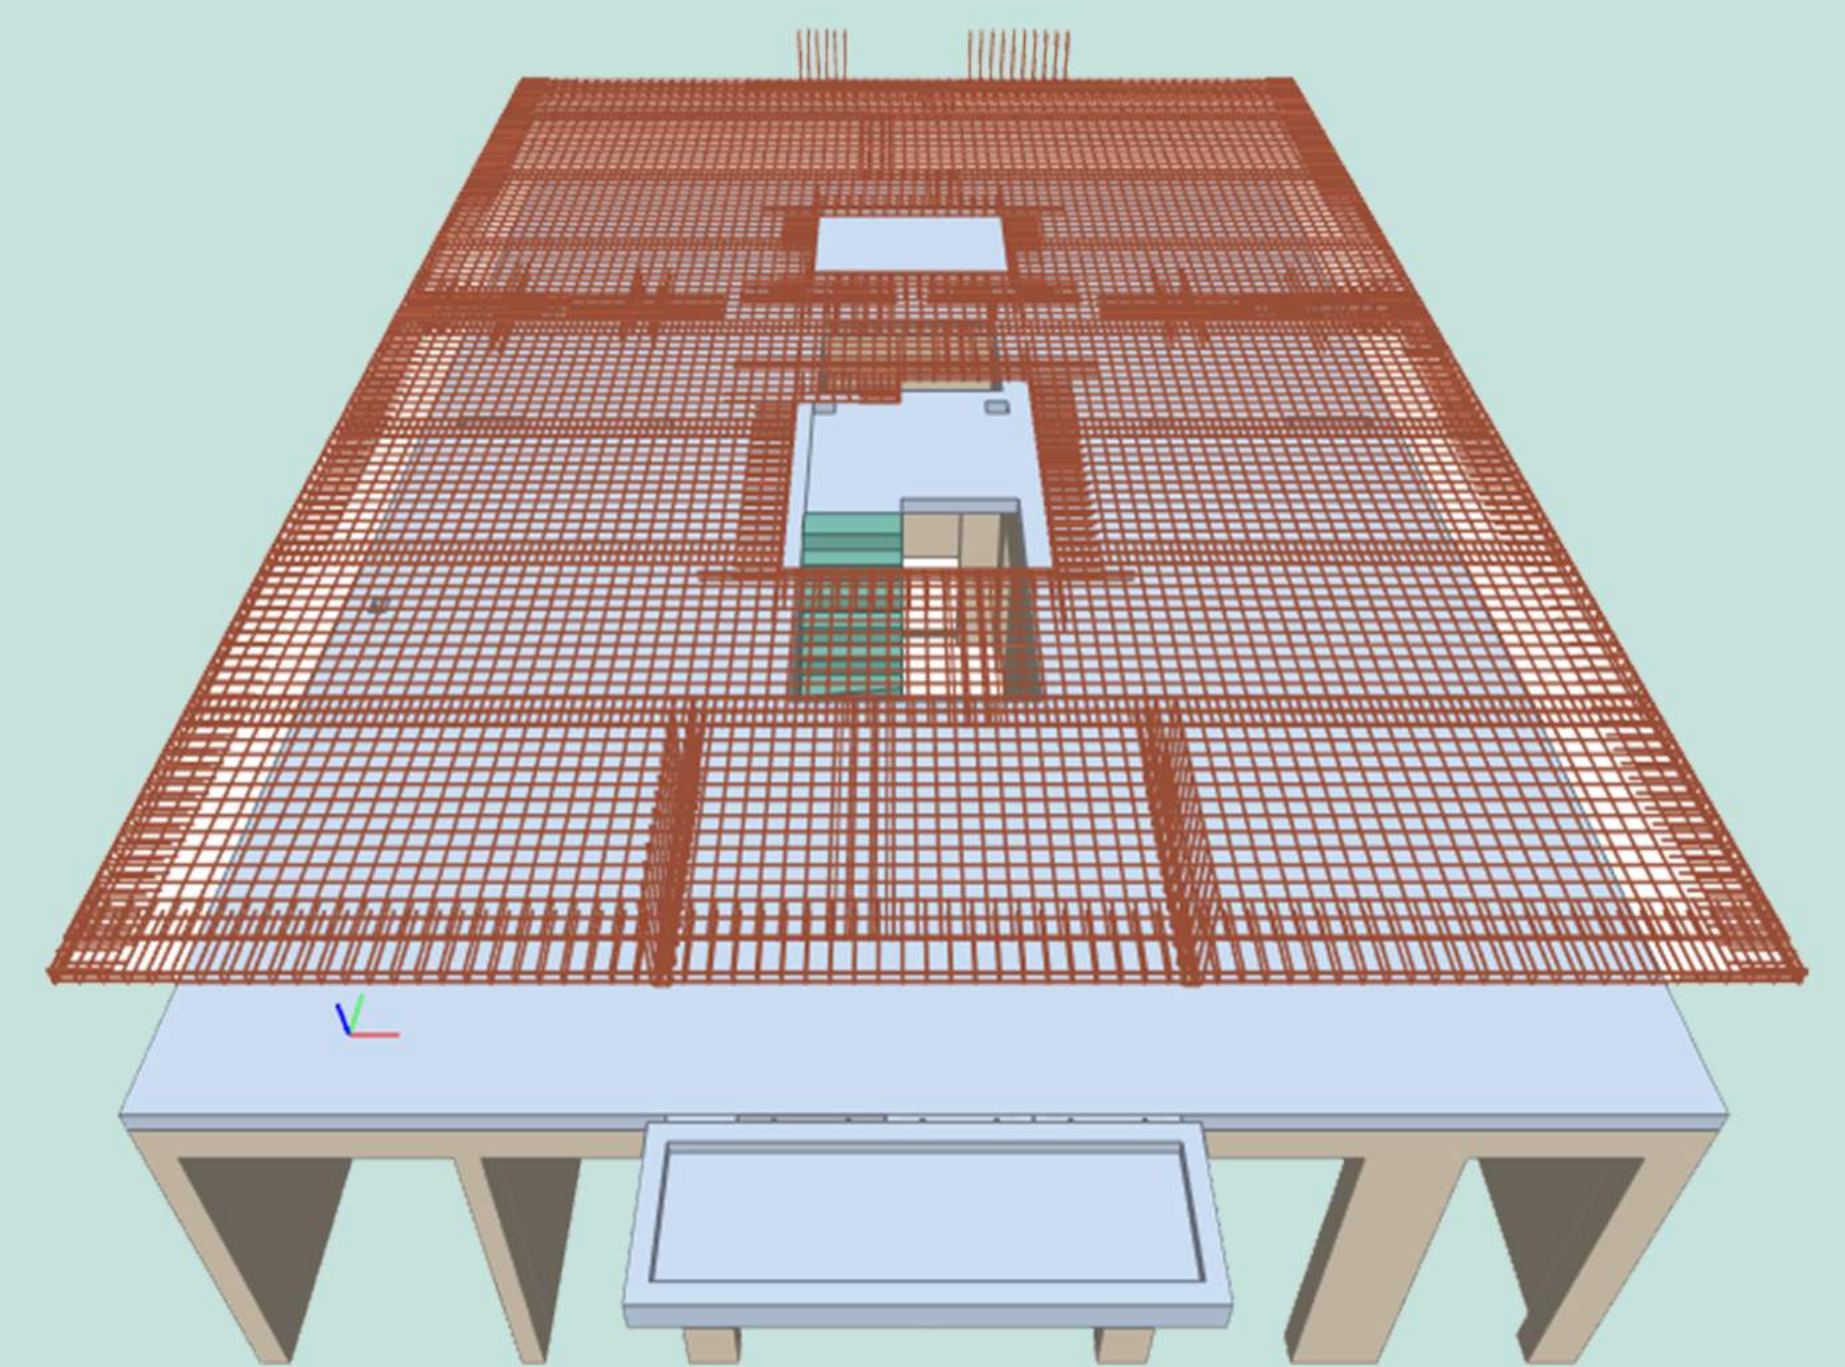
IFC – Modell mit der Bewehrung, untere Lage
